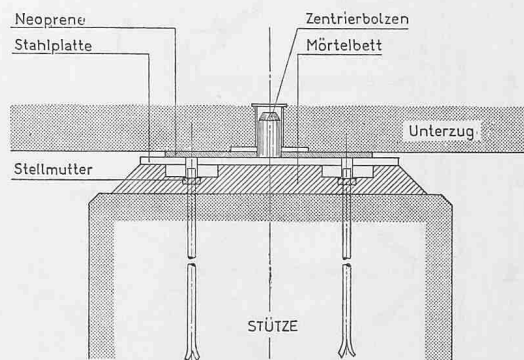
Gelenkanschluss der Pendelstütze an einen Unterzug in den Untergeschossen. Masstab 1:15
